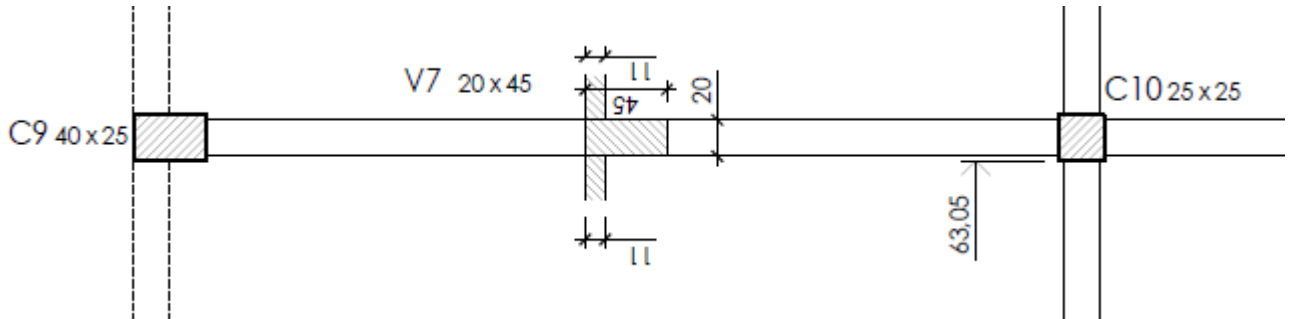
Esquema estructural viga 7 (Fuente: Elaboración propia)
